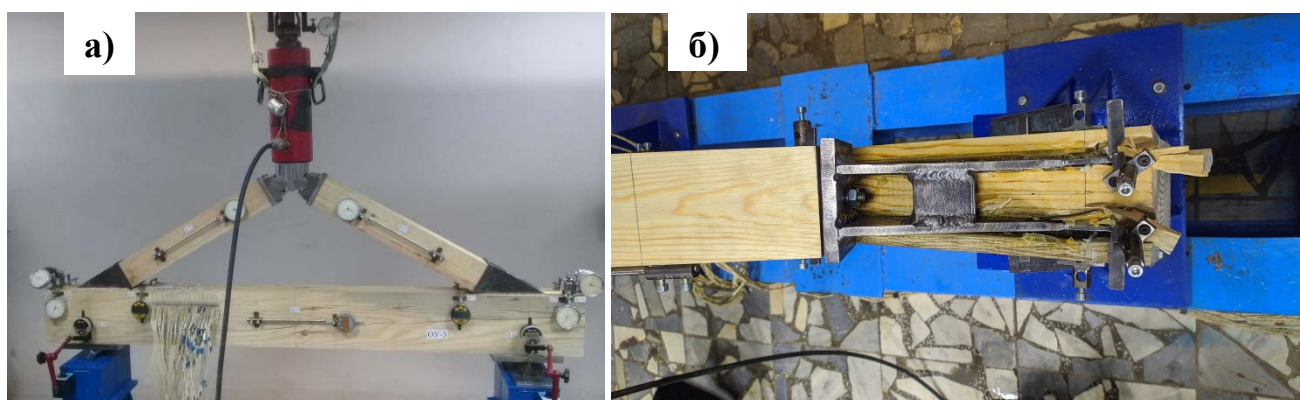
Общий вид установки для испытания опорного узла фермы (а) и характер разрушения опытного образца (б)
